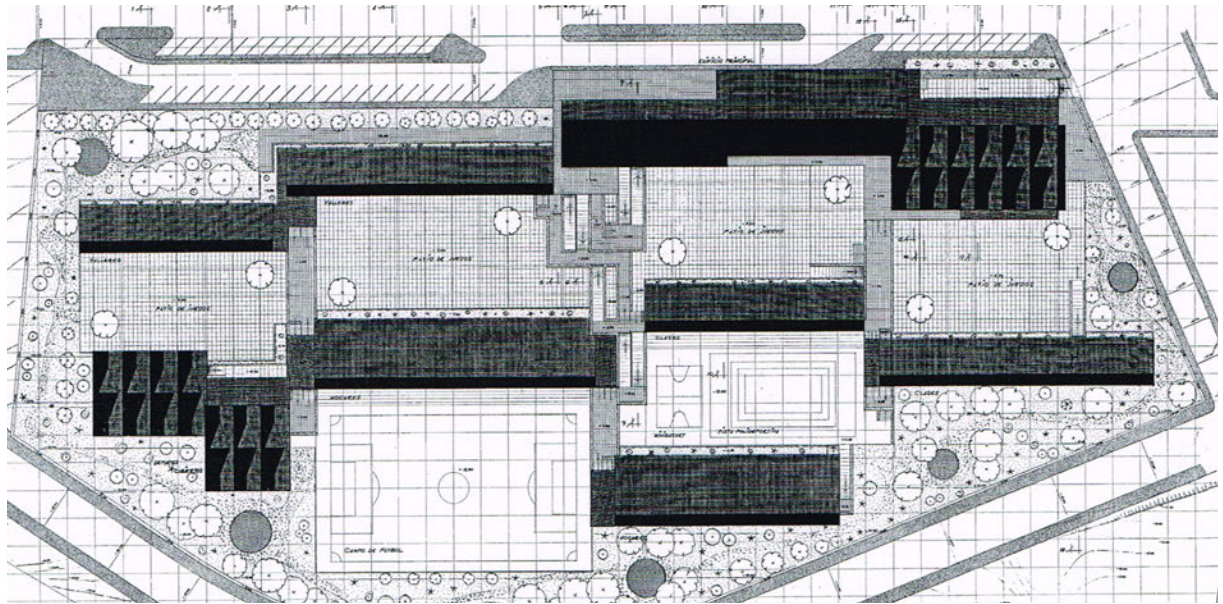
Planta general del conjunto. Imagen: Archivo Rubens Henríquez.
